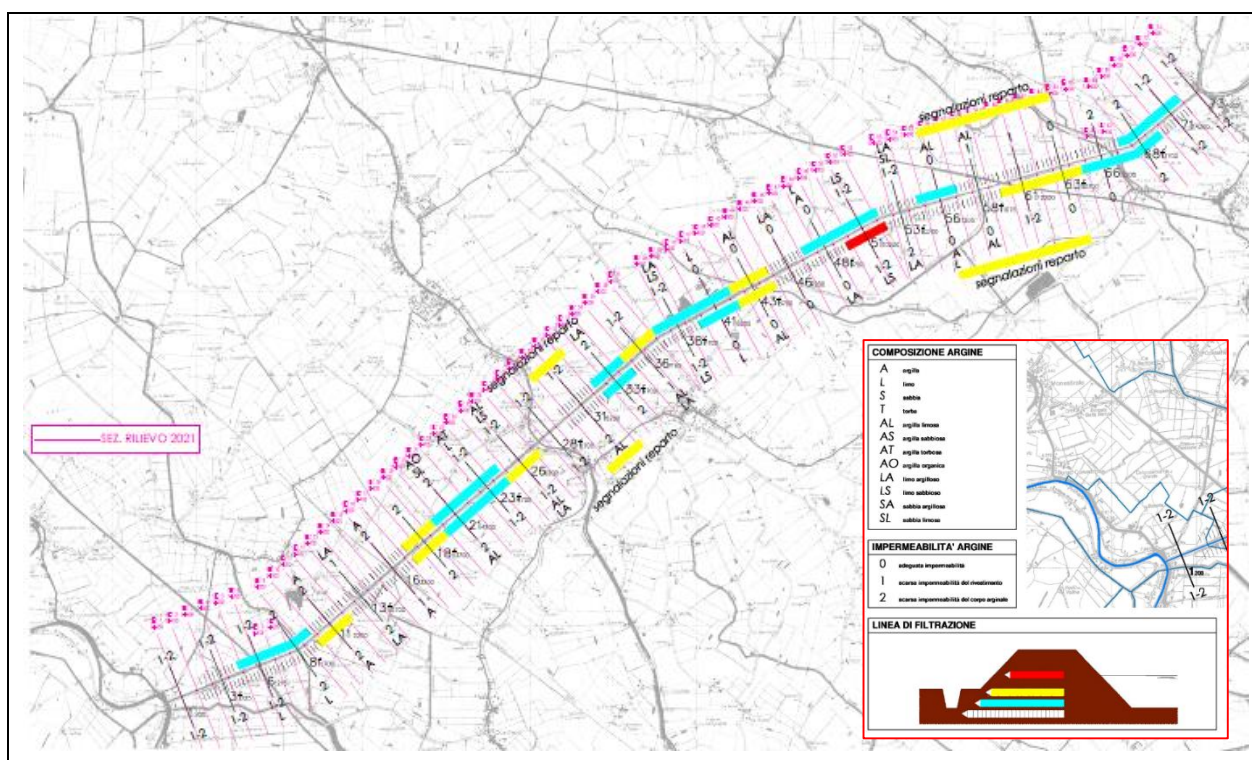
Estratto dall'elaborato "PE-05-01 Planimetria con ubicazione indagini 2010"
